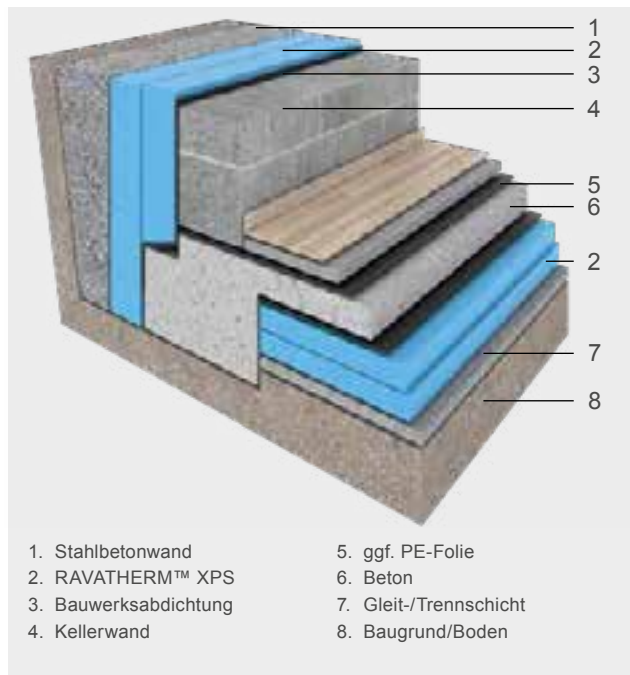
Detailbeispiel Fußpunkt Kelleraußenwand und Wandanschluss
